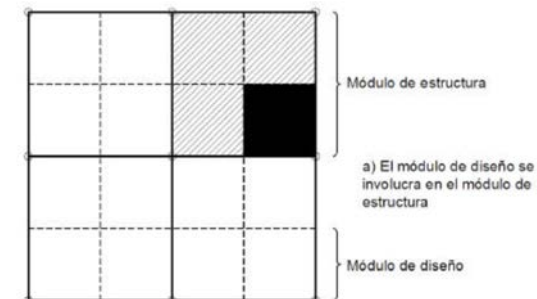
Ilustración de módulo de estructura conteniendo módulos de diseño. Fuente: Procesos Constructivos Taller Vertical N°1. (2020)
